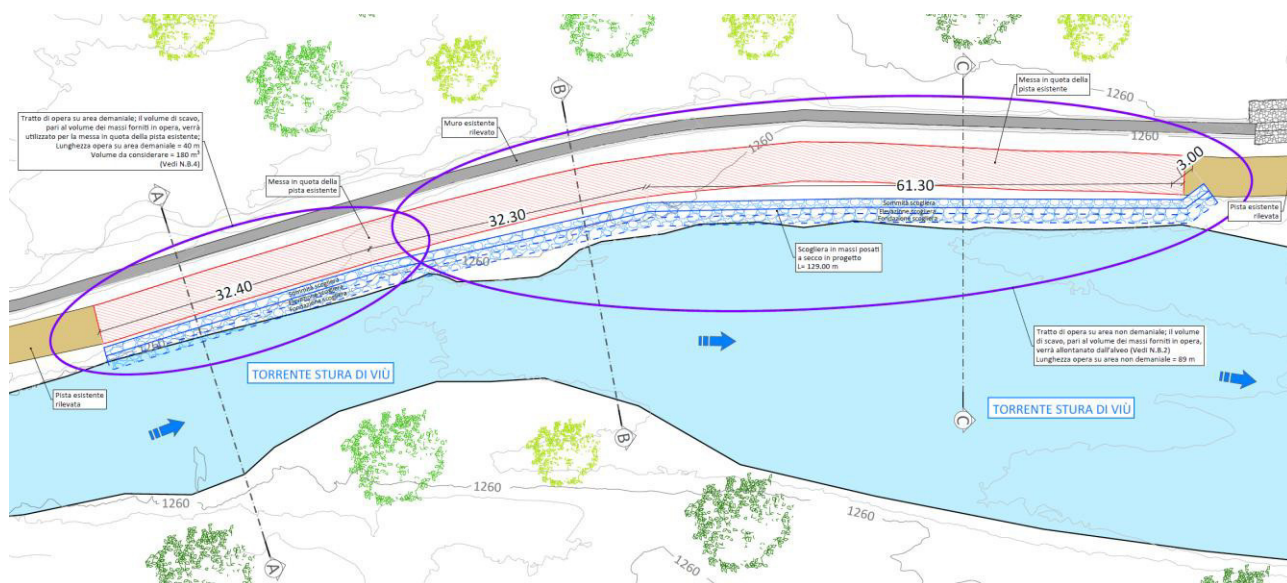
Estratto della tavola 05.1 - Planimetria di progetto Intervento 1
